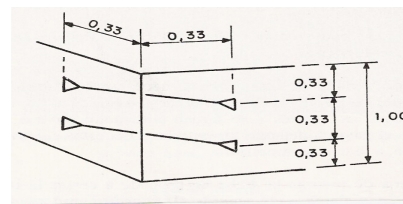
Detalle de tirantes horizontales. (Suárez, 1993).
